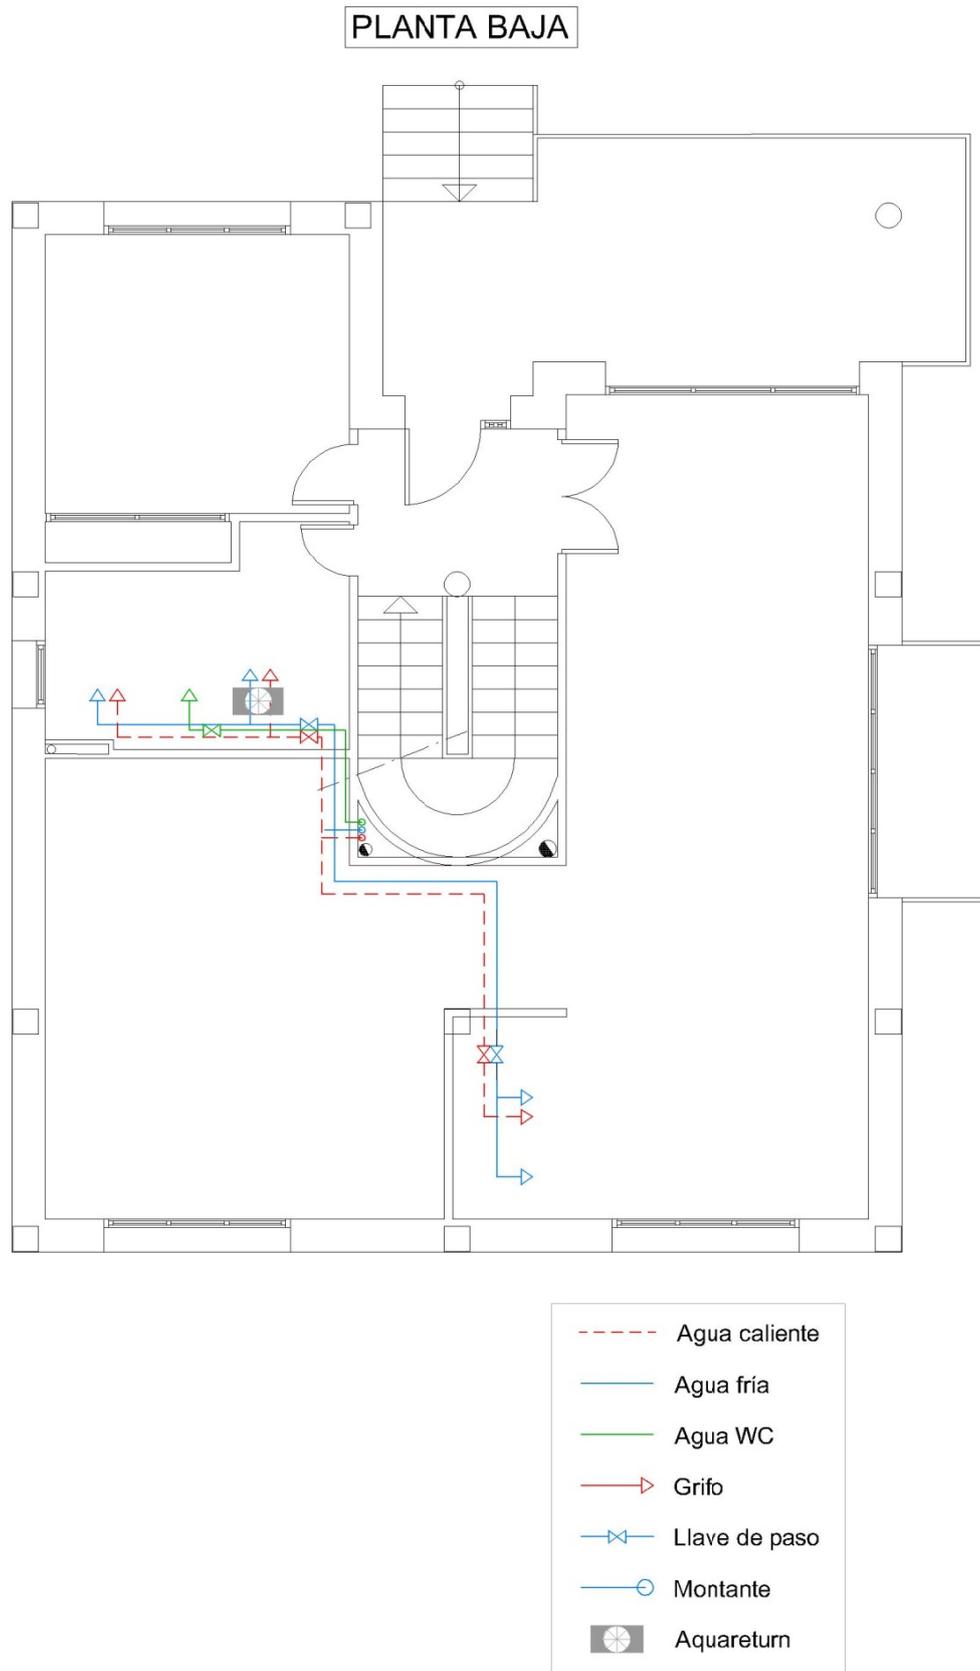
Plano instalación sistema Aquareturn en Planta Baja
